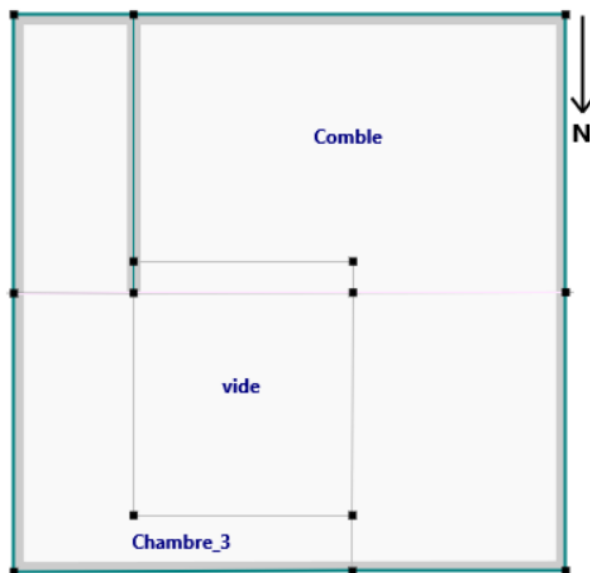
Le plan en 2D du niveau 1 du chalet.
